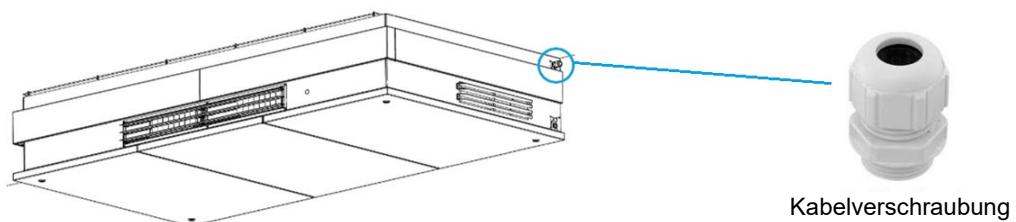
Einführung für Versorgungskabel und Kabelverschraubung
